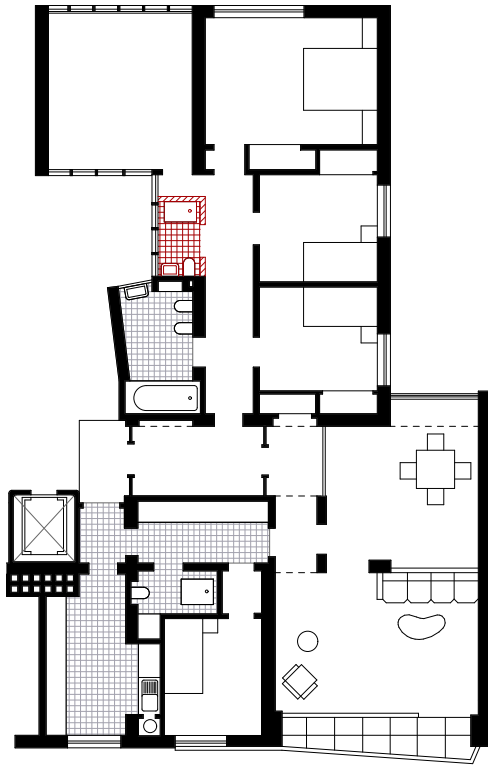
Planta c\ sugestão da alteração referida no texto
